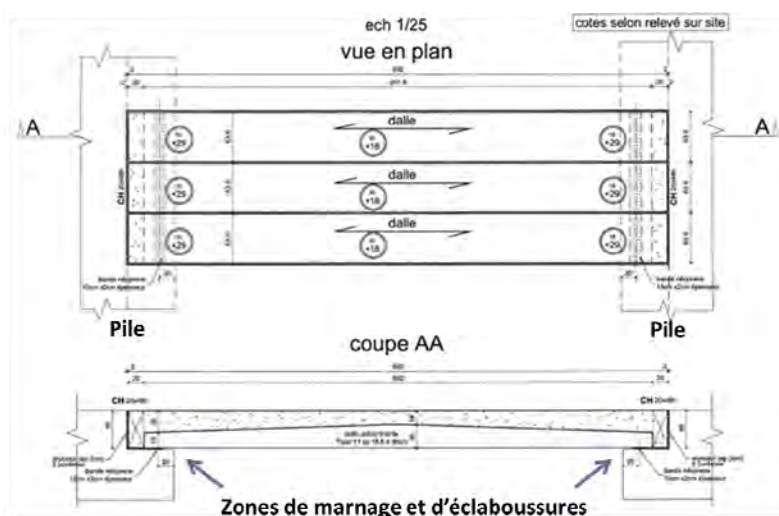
Vue en plan et coupe des dalles constitutives d'une travée entre deux piles.
